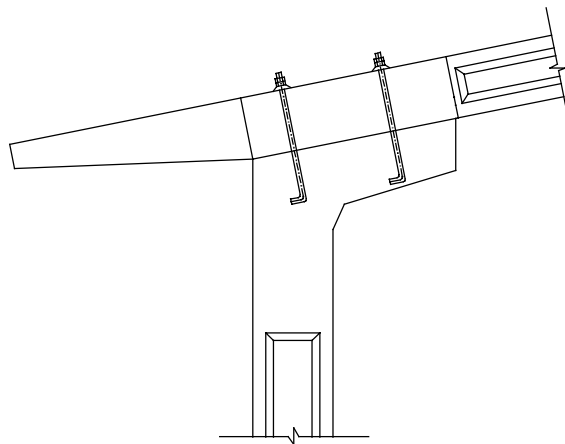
Ligação viga-pilar executada através de consolo e chumbador.
